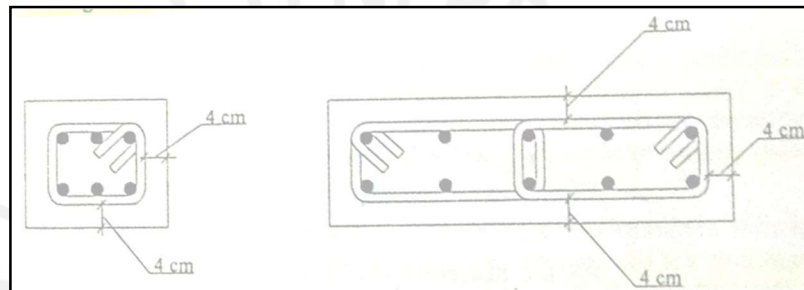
Recubrimiento en Columnas. (Fuente: Apuntes del Curso Concreto Armado 1, Ottazzi 2010).
